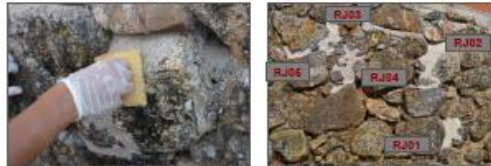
Aplicação das argamassas de substituição numa parede exterior às ruínas com características semelhantes.
